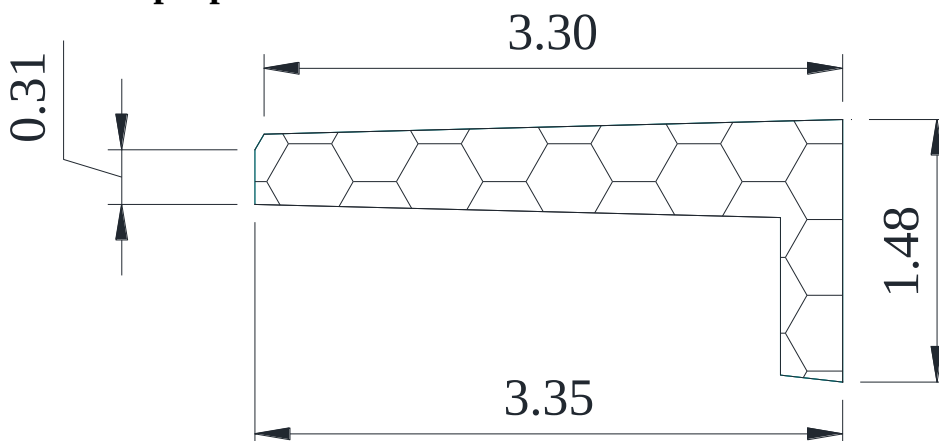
Coupe transversale du trottoir de droite avec corniche.
